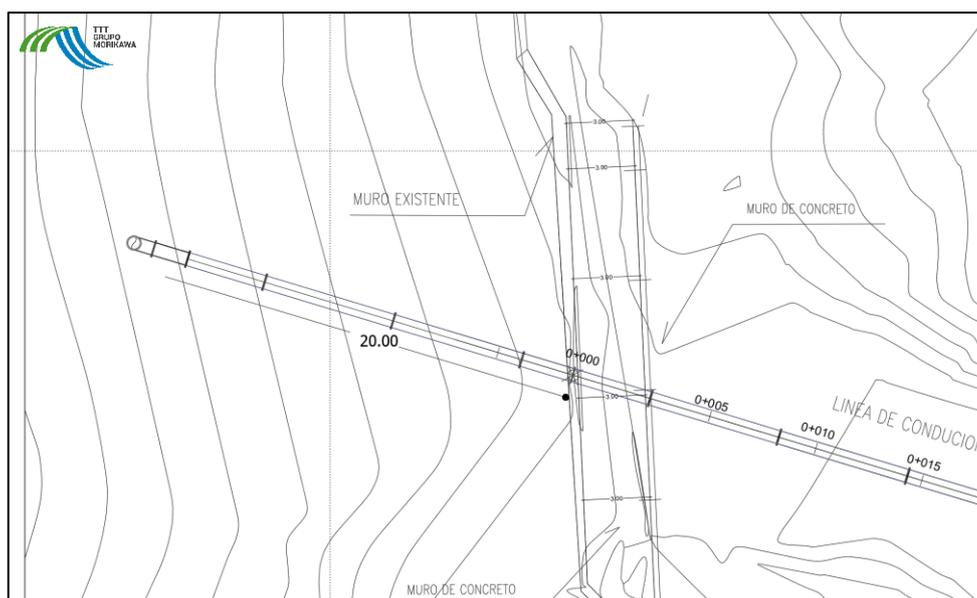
VISTA EN PLANTA AMPLIACIÓN DE TUBERÍA DE EMISOR SUBACUÁTICO / FUENTE: PROPIA
